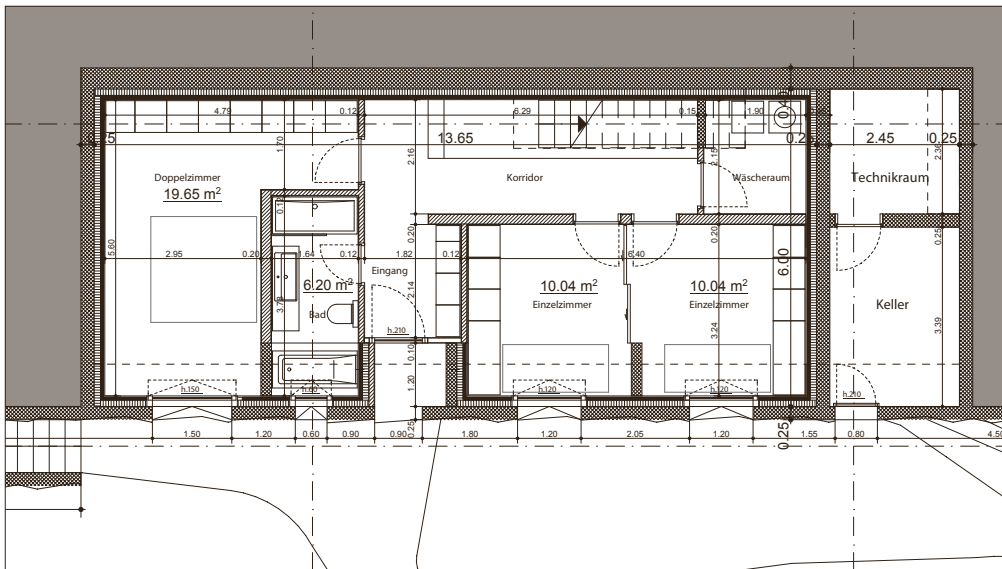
Grundriss Erdgeschoss.
